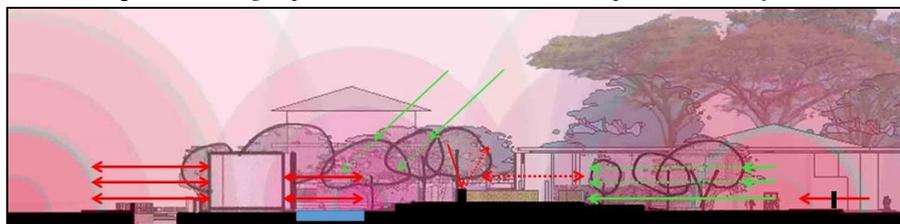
Potongan peran tatanan elemen vertikal pada Plaza
